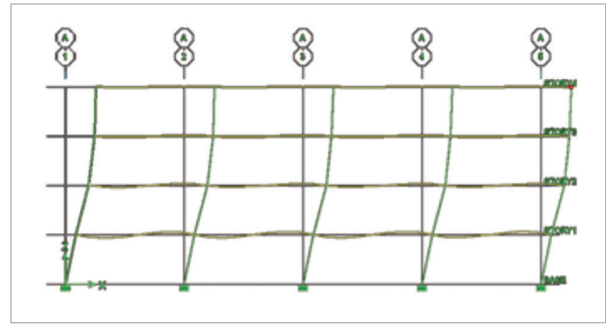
Deformación de la estructura bajo cargas laterales de tsunami.
